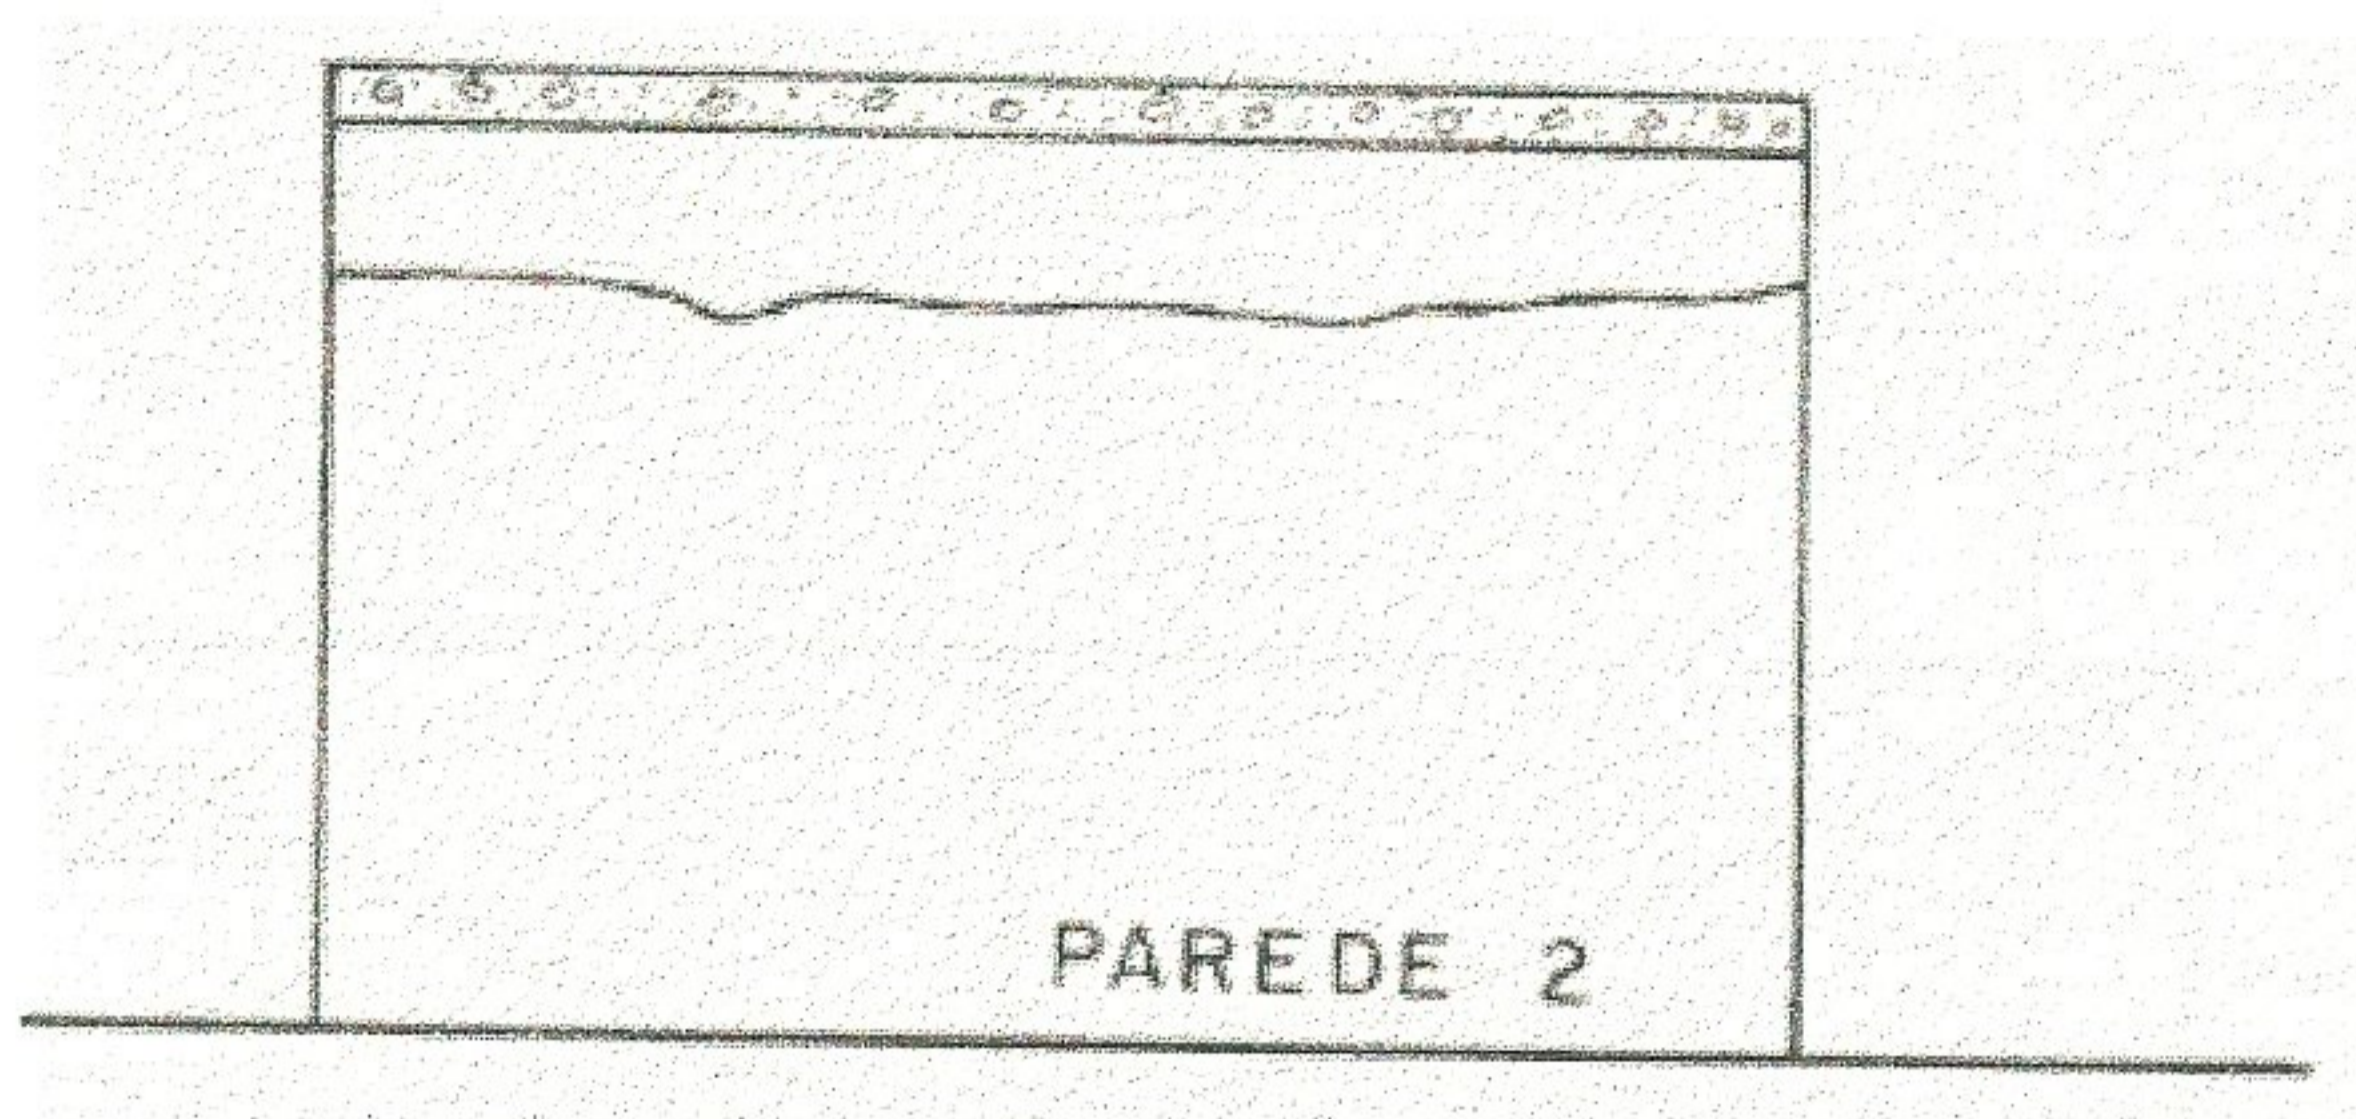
Fissura típica presente no topo da alvenaria paralela ao comprimento da laje. [22]
